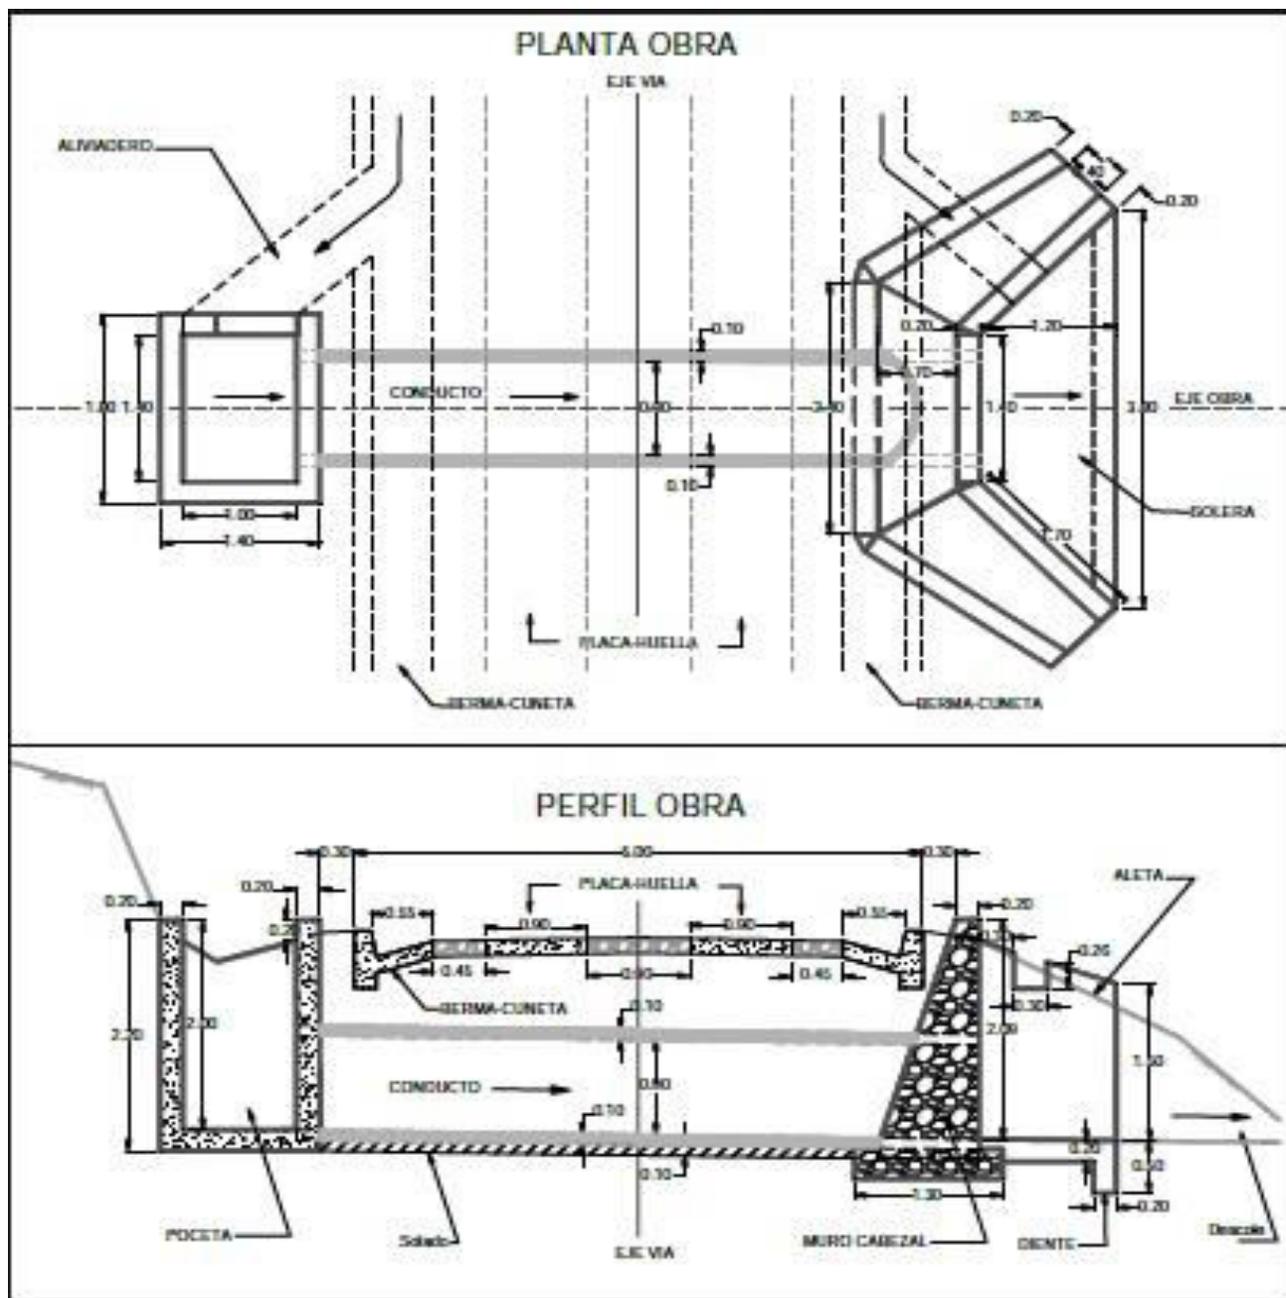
Vista en planta y perfil de Alcantarilla tipo para drenaje.
